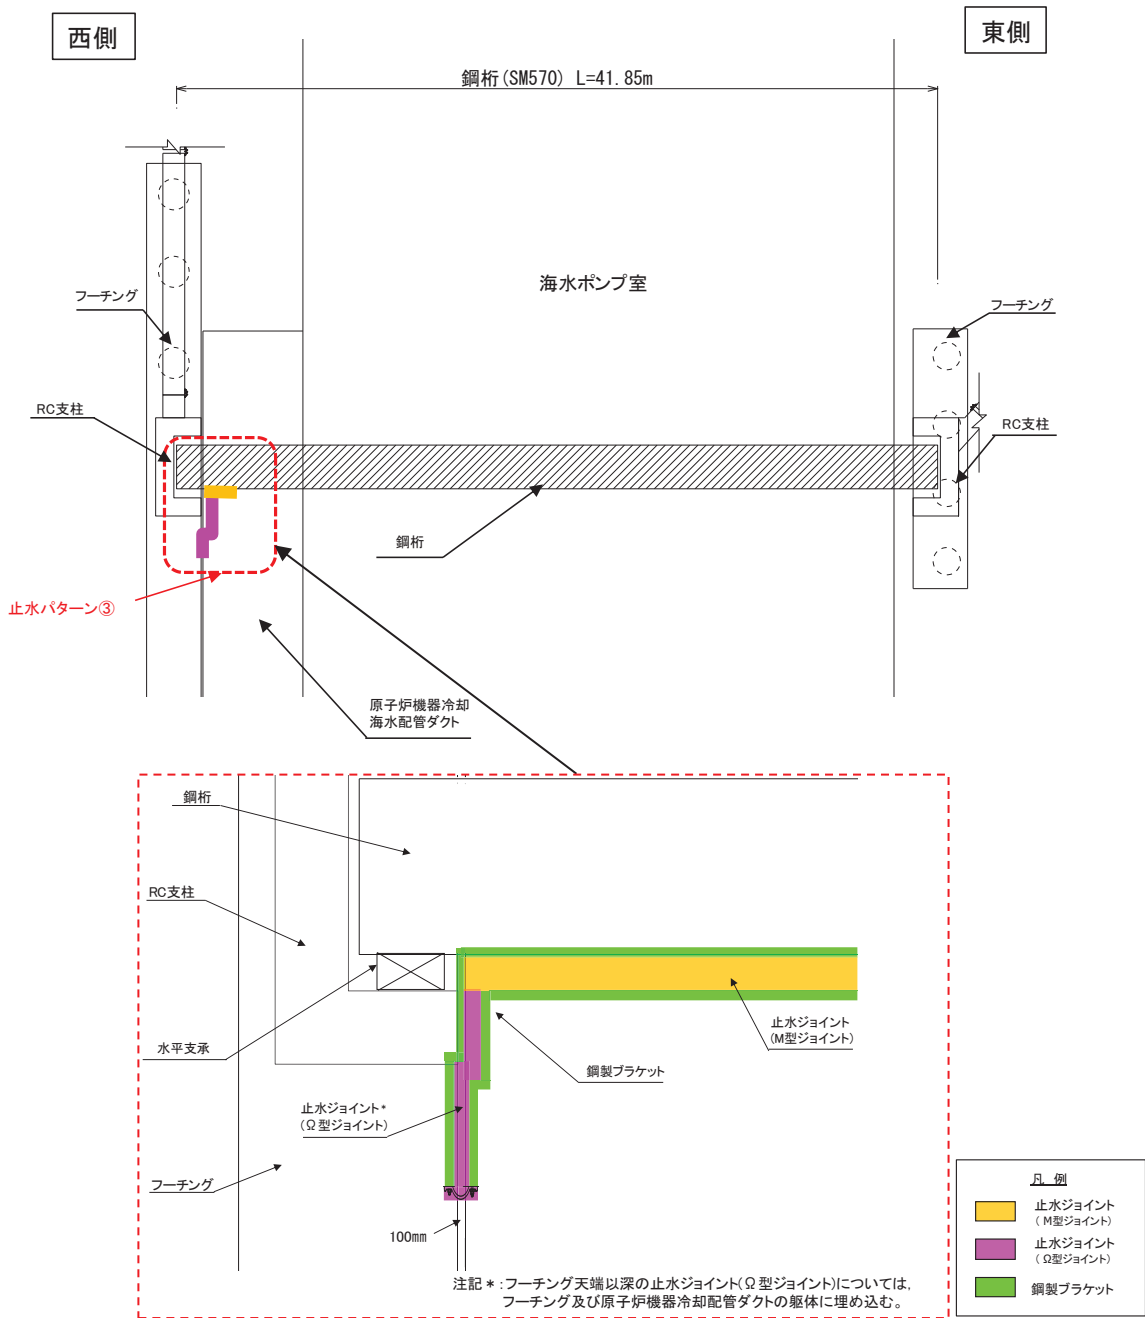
(2) 止水パターン③の構造概要(平面図)
